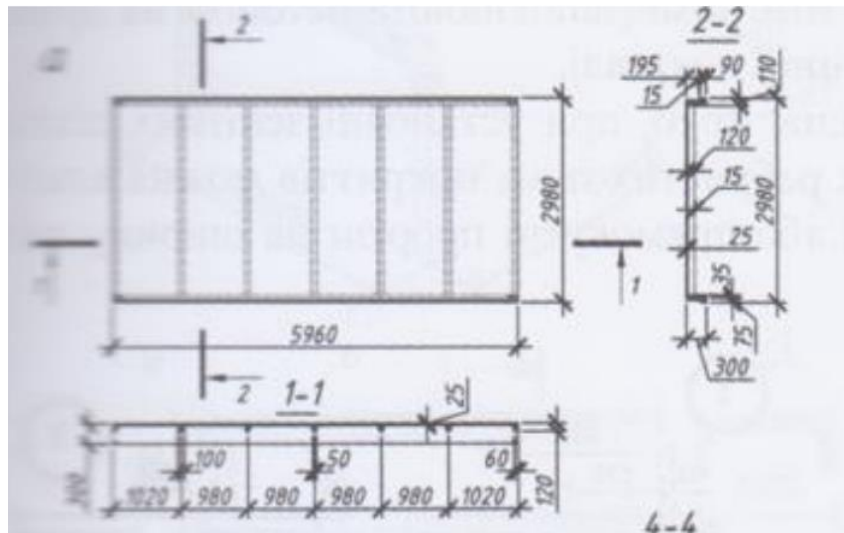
Залізобетонна збірна ребриста плита покриття
